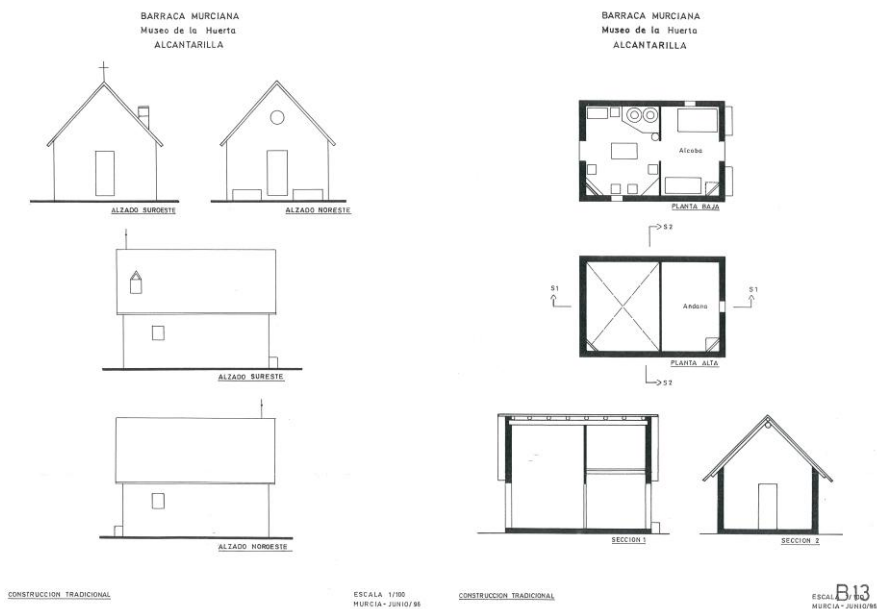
Barraca murciana - Plantas, Alzados y Secciones
